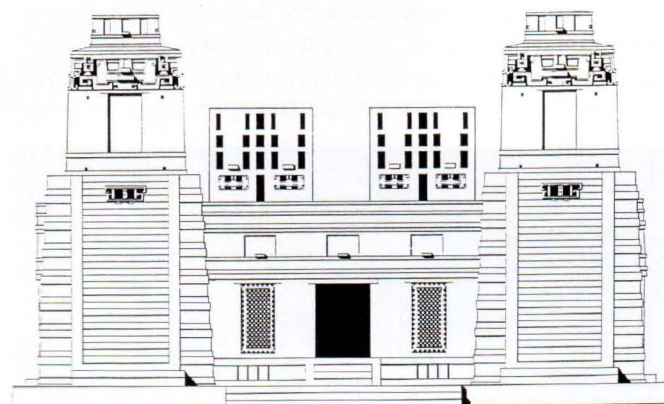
Alzado este del edificio de Río Bec B. En él se observan tableros y las celosías de la crestería.
